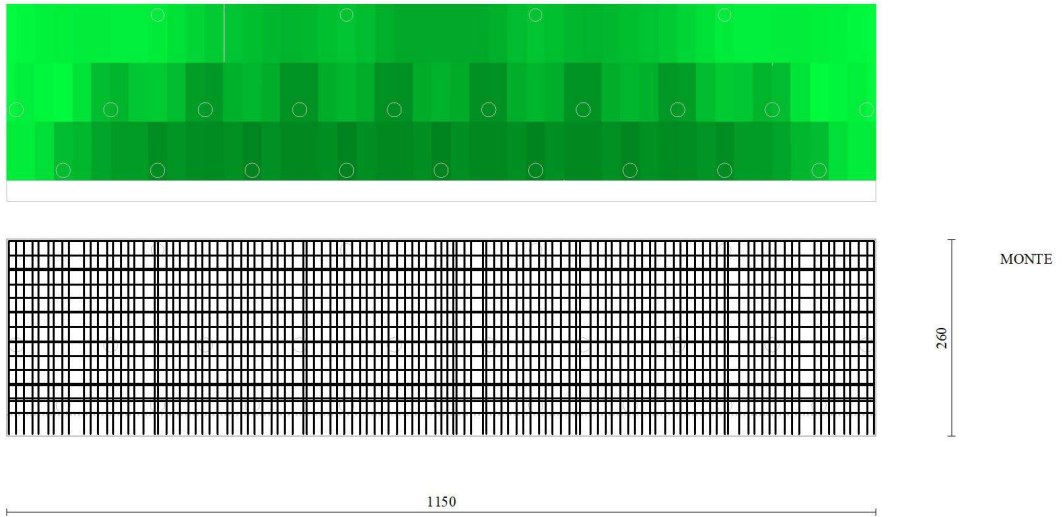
Piastra fondazione dir. X (Inviluppo)
